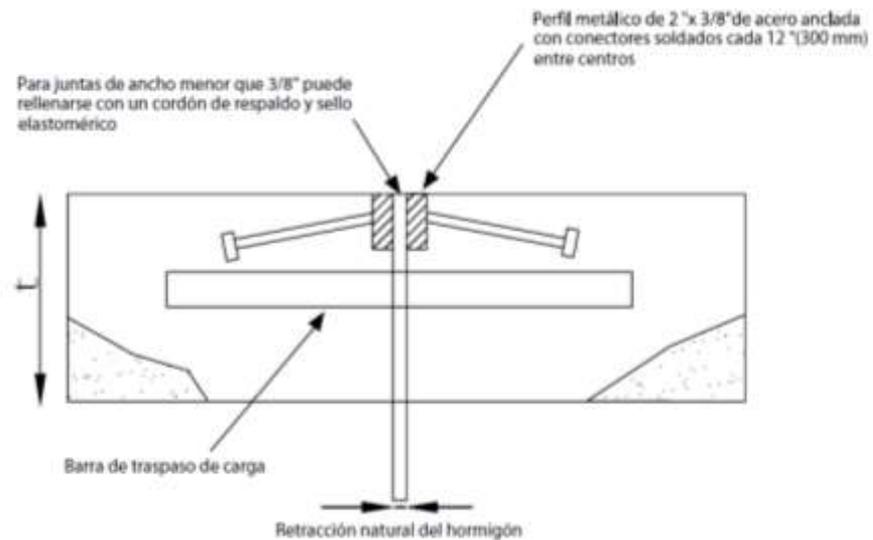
Detalle de junta de construcción protegida con cantonera. (ACI 360R-10)
